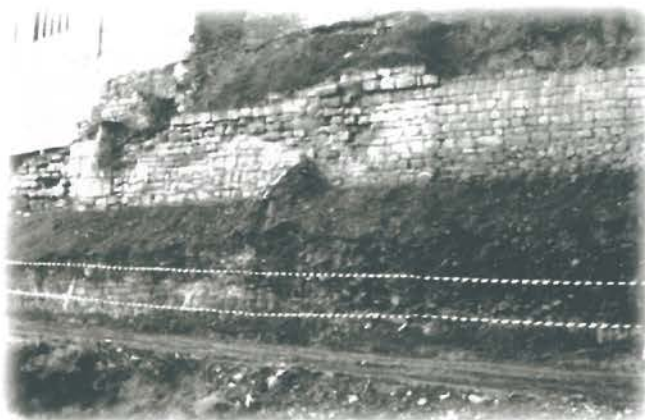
El sector de muralla situado en el camino de Bellavista después de la excavación.
